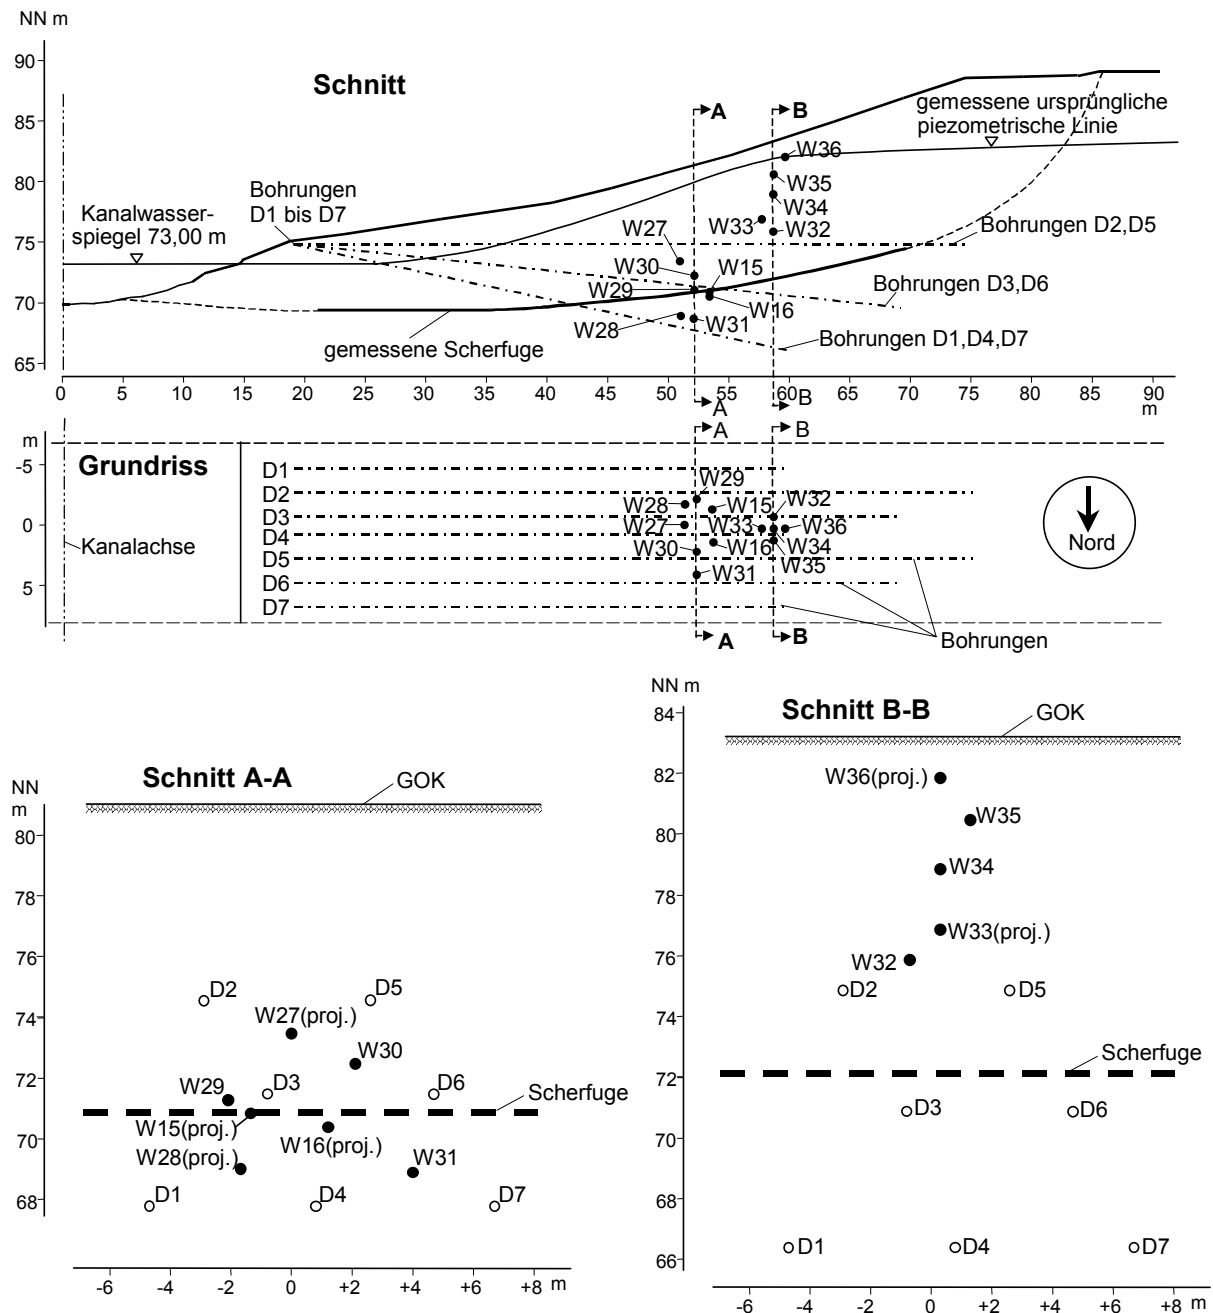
Lage der Druckentlastungsbohrungen (D) und der Porenwasserdrucksensoren (W), Grundriss und Schnitte
